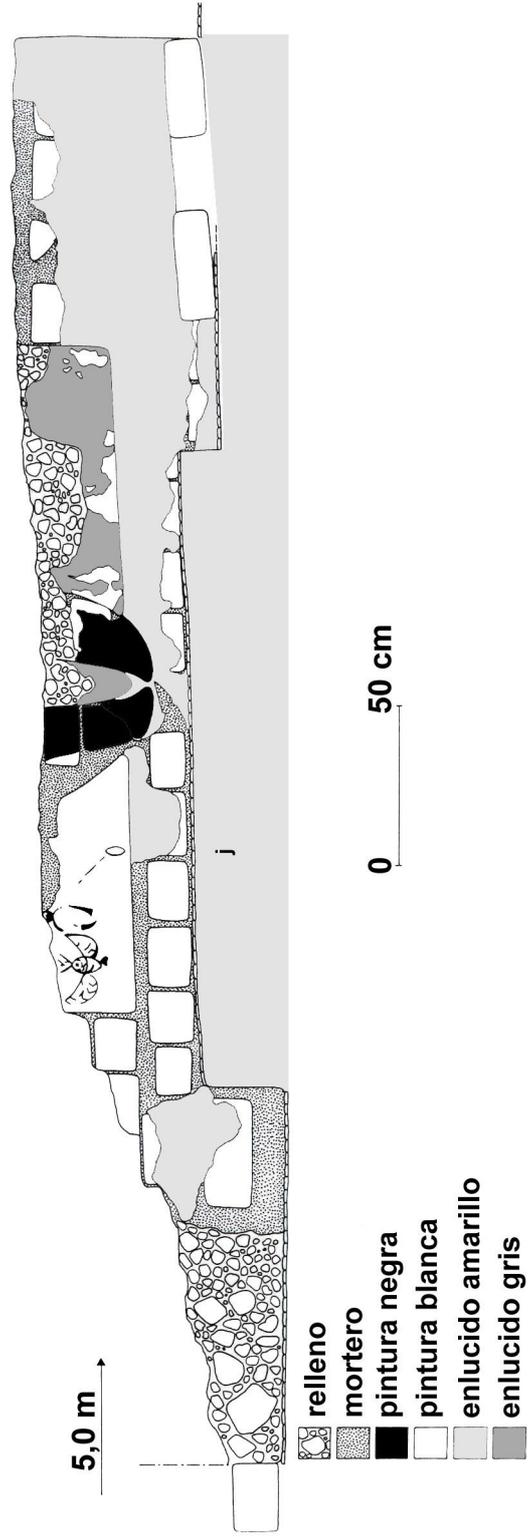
Dibujo del muro pintado sur del ambiente #6, Terraza Este Bajo
